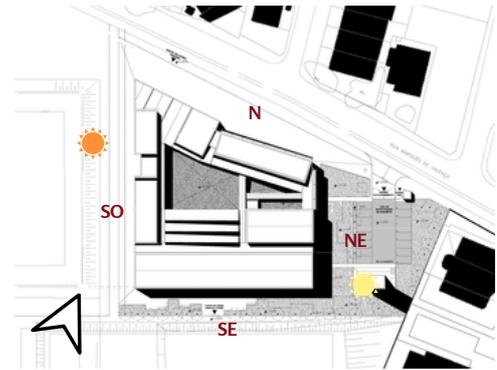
Planta de Localização e Coberta da ETE Cícero Dias, com edição autoral.
